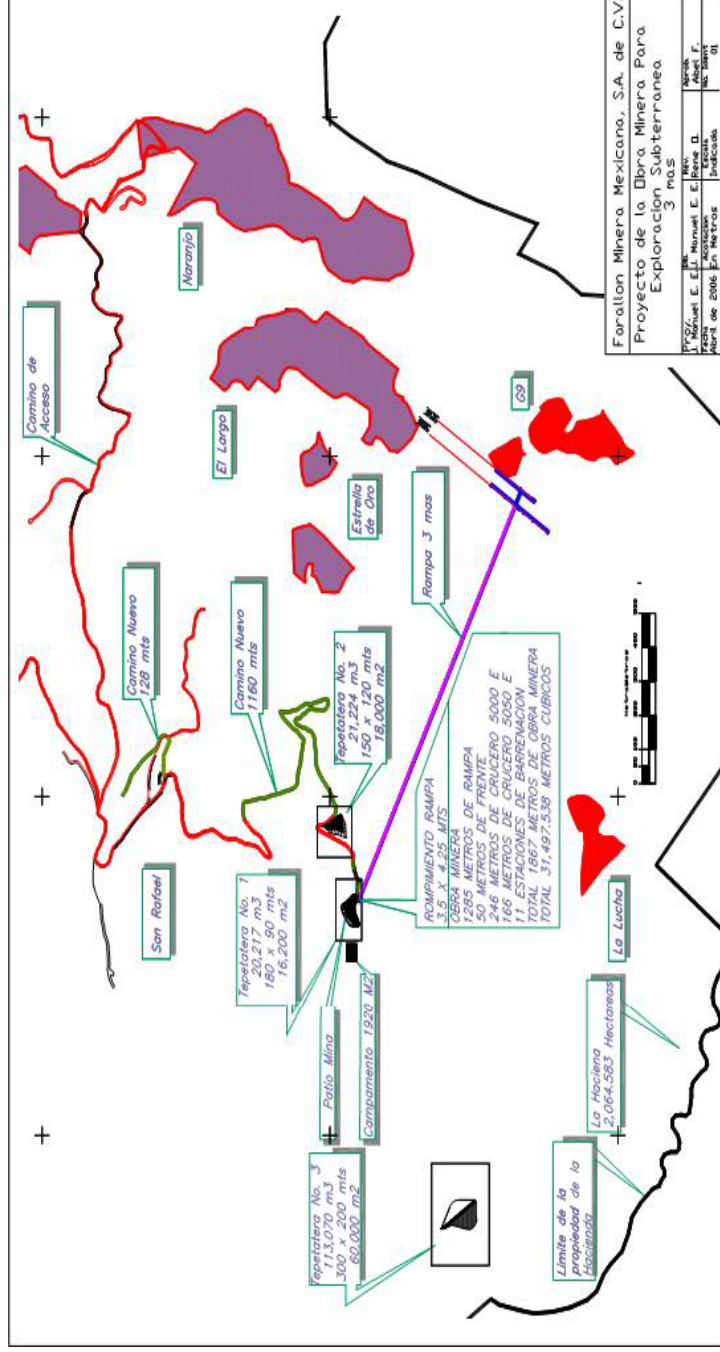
Ubicación de las tepetateras y la infraestructura ya autorizadas por SEMARNAT en la etapa de exploración.
